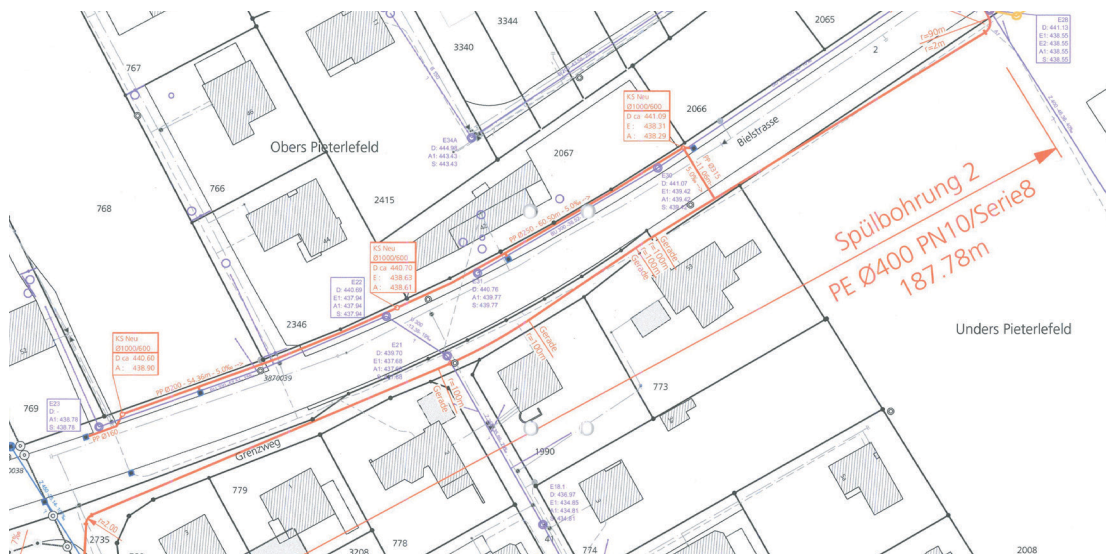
Planausschnitt Baugesuch «Neubau Regenwasserkanal Gummen»; orange: der proj. Regenabwasserkanal
